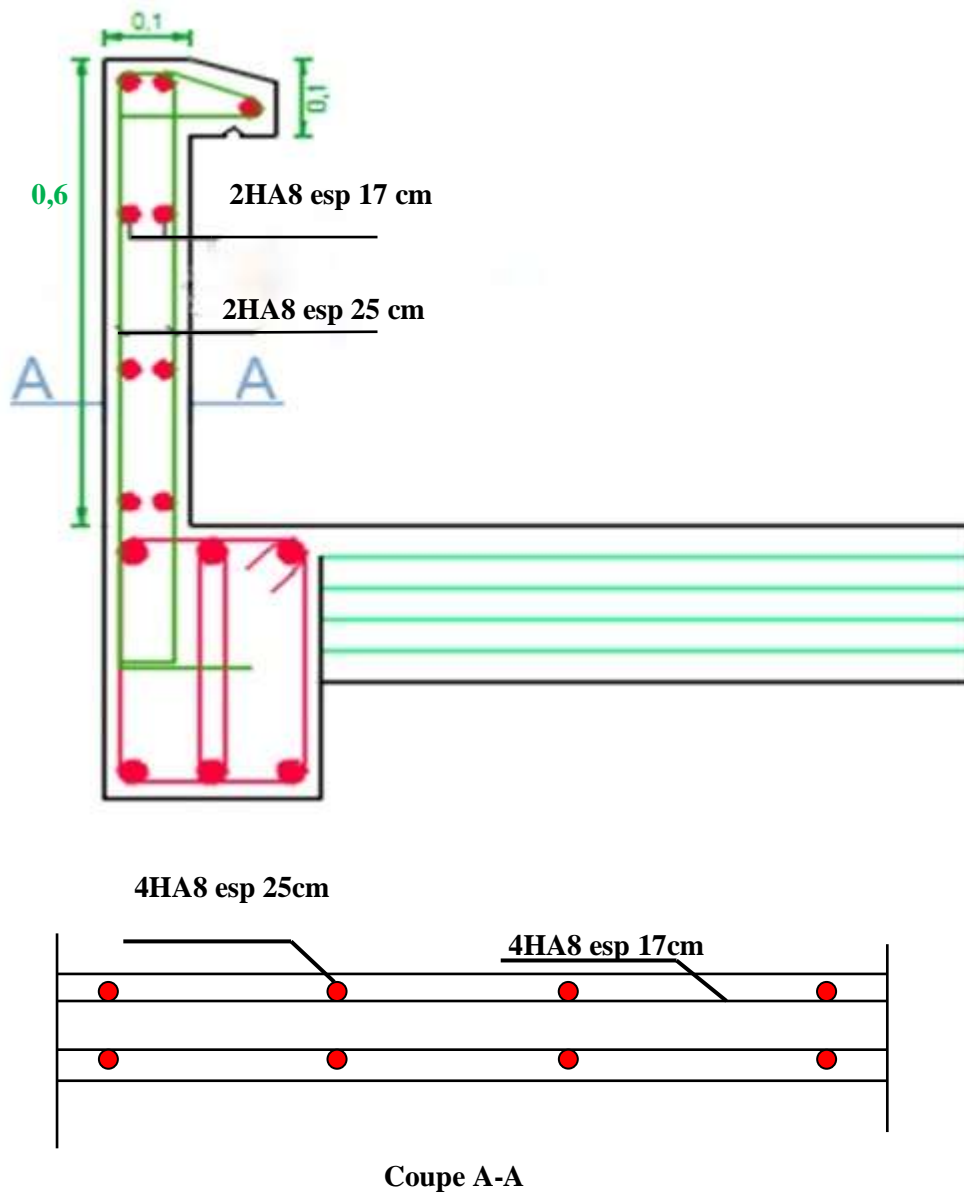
schéma du ferrailage de l'acrotère.
